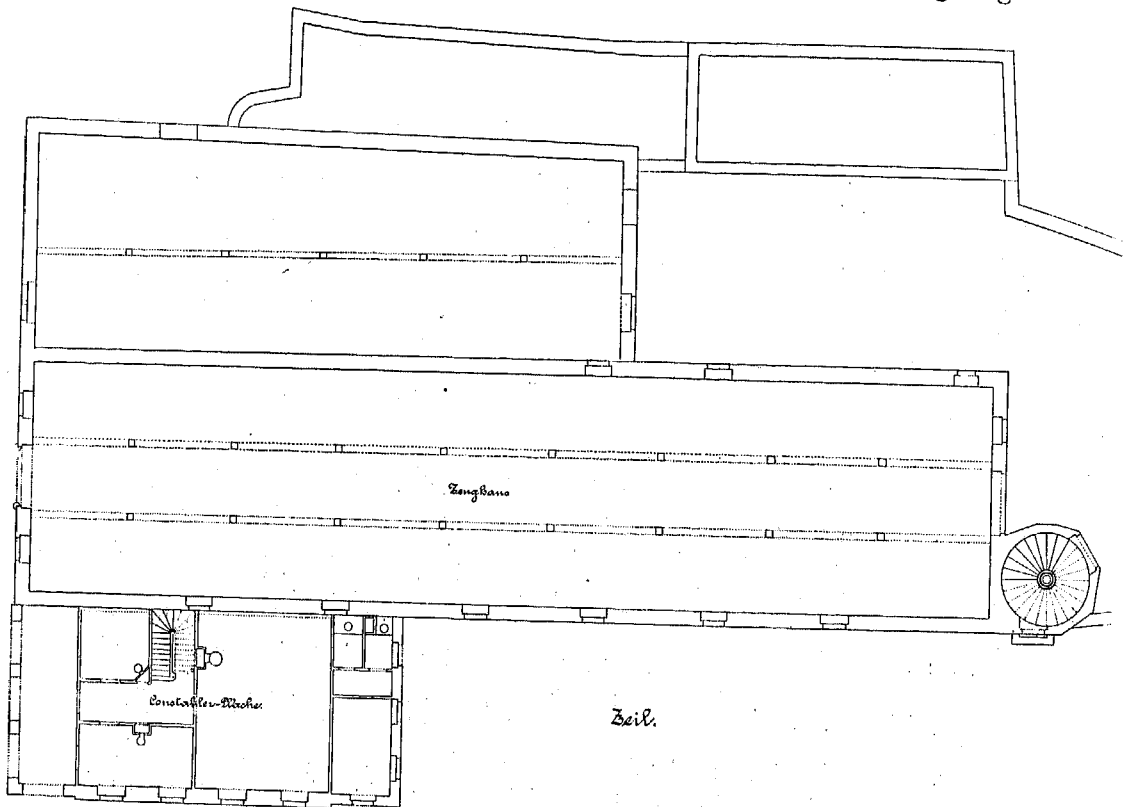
Konstabler-Wache; Grundriss.
